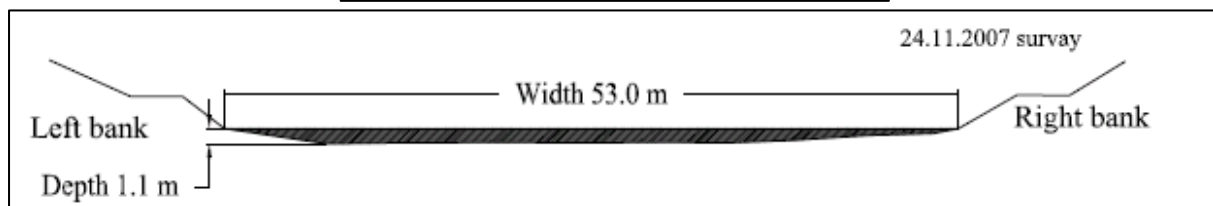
CS1 地点 (UN Bridge) の河川断面図
